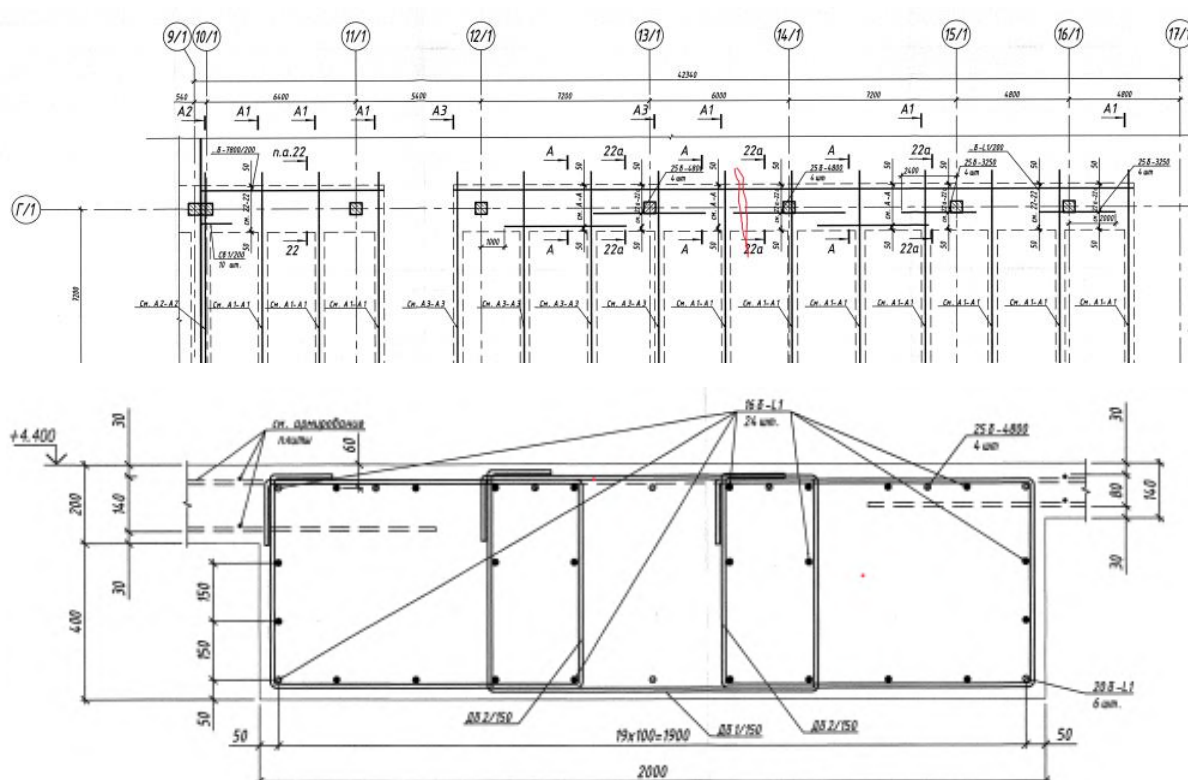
Принципиальная схема армирования главной балки по оси Г/1 (план и сечение посередине пролёта 13/1-14/1)
